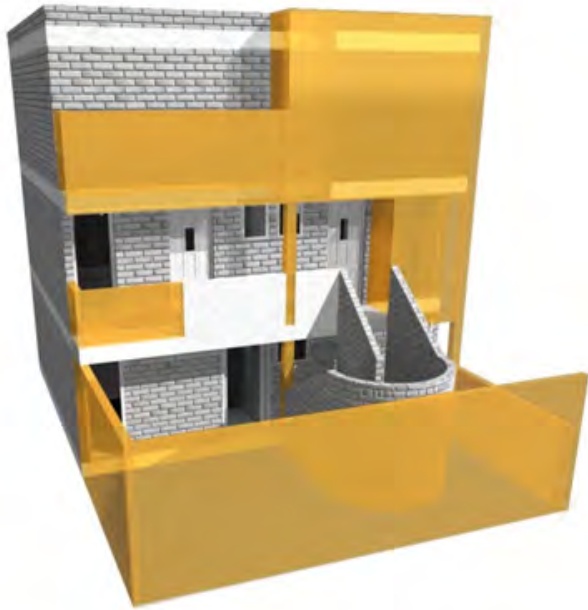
Modelo en 3D del Edificio D indicando con color la modificación por construcción que presenta la vivienda. Fuente: propia 2018
